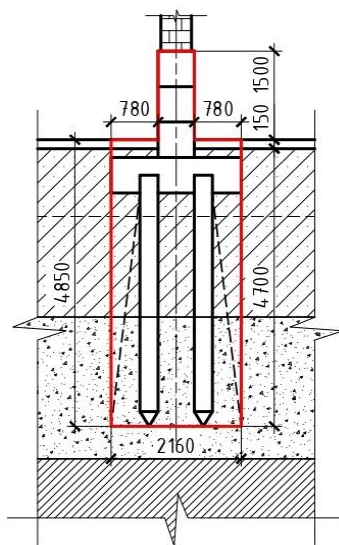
Схематичне зображення фундаменту під внутрішню стіну
